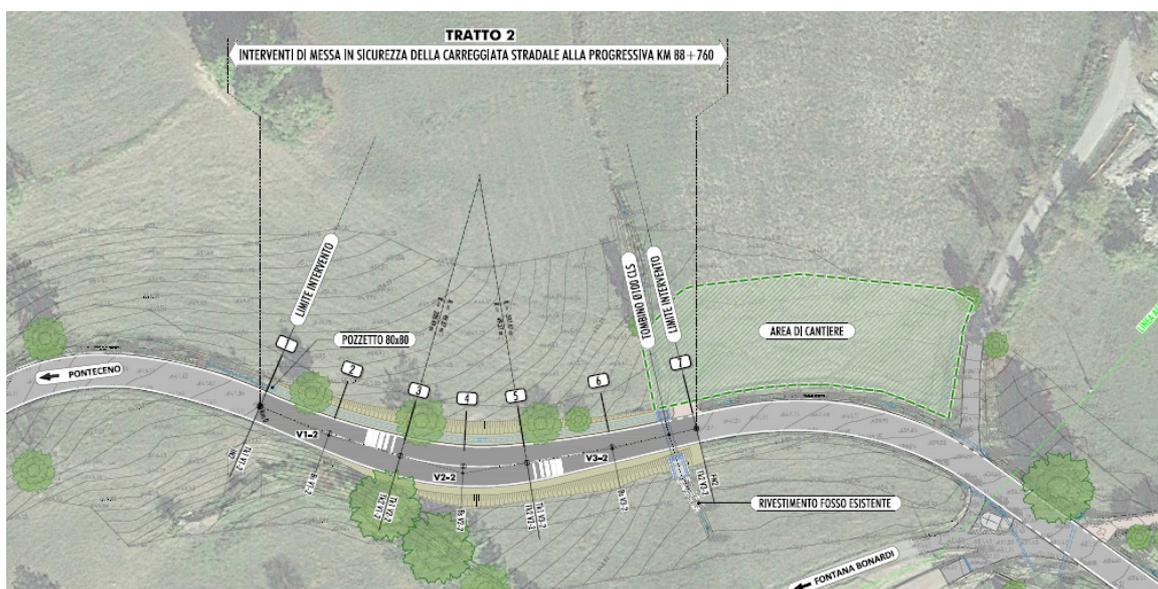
INTERVENTO TRATTO 2 – STRALCIO PLANIMETRICO
